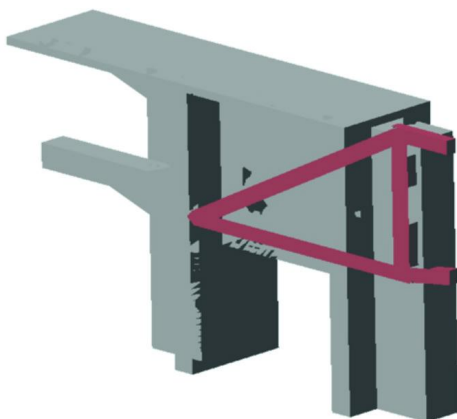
Схема принятого узла сопряжения в зоне опирания стальных ферм на монолитные конструкции (общий вид)
